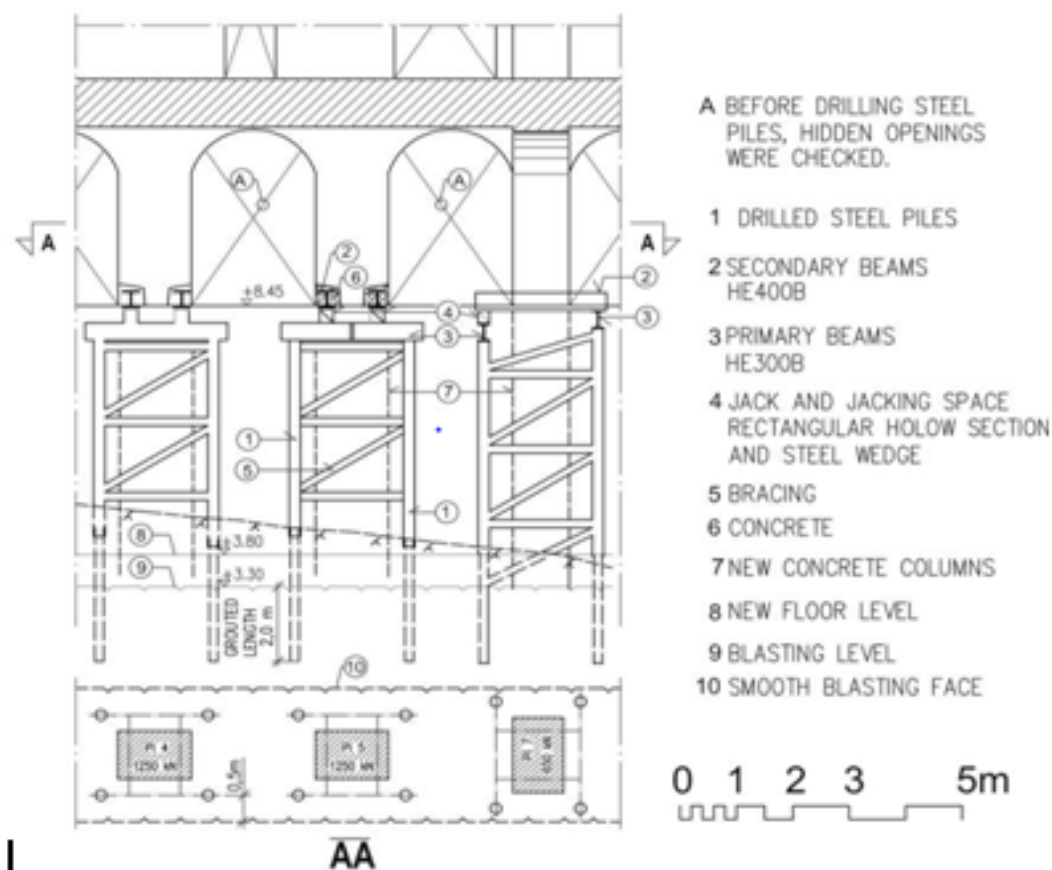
Corte esquemático da estrutura de suporte provisória da parede do meio (Avellan, 2010)
